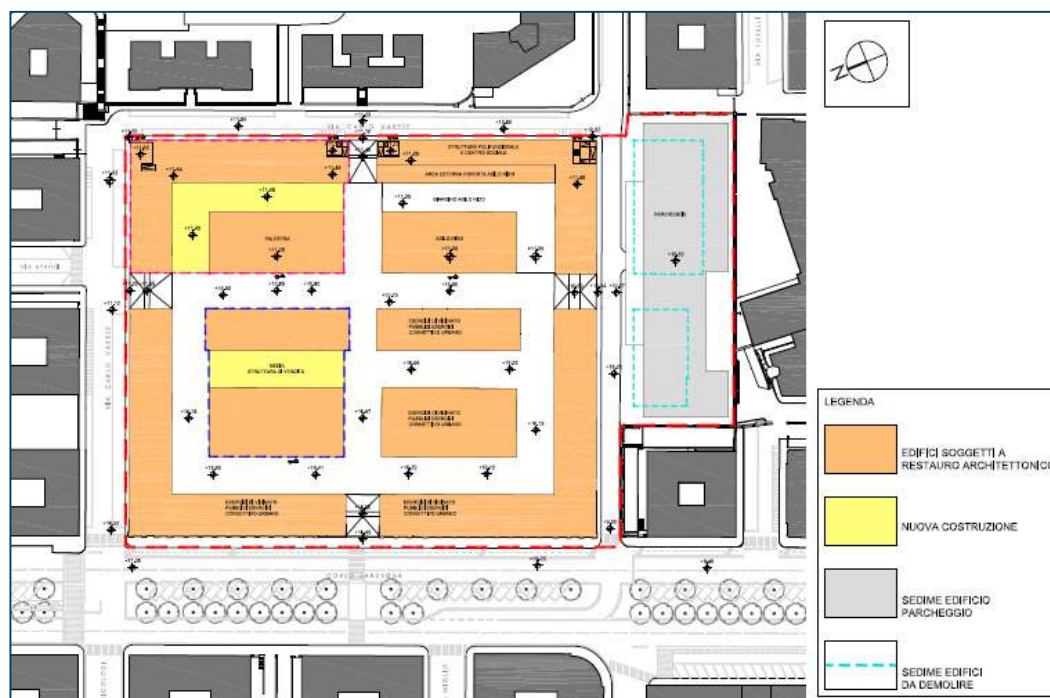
Modifiche all'assetto degli edifici previsti dall'intervento di restauro architettonico: in arancione i fabbricati esistenti, in giallo le nuove costruzioni, con tratteggio azzurro gli edifici oggetto di demolizione e in grigio quello di nuova costruzione destinato a parcheggio.
